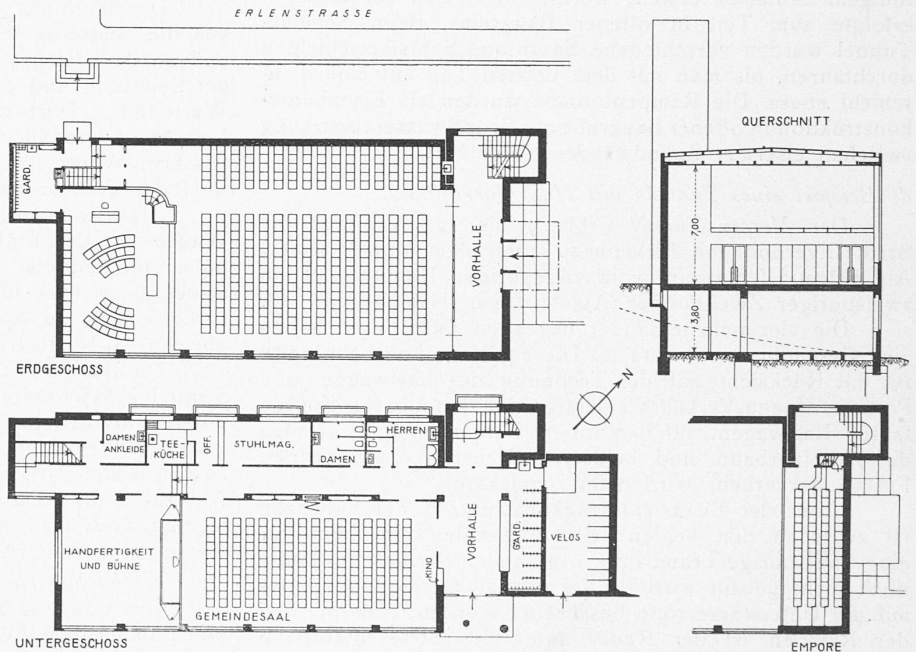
Grundrisse und Querschnitt der Kirche Gerliswil. — Masstab 1 : 400.
